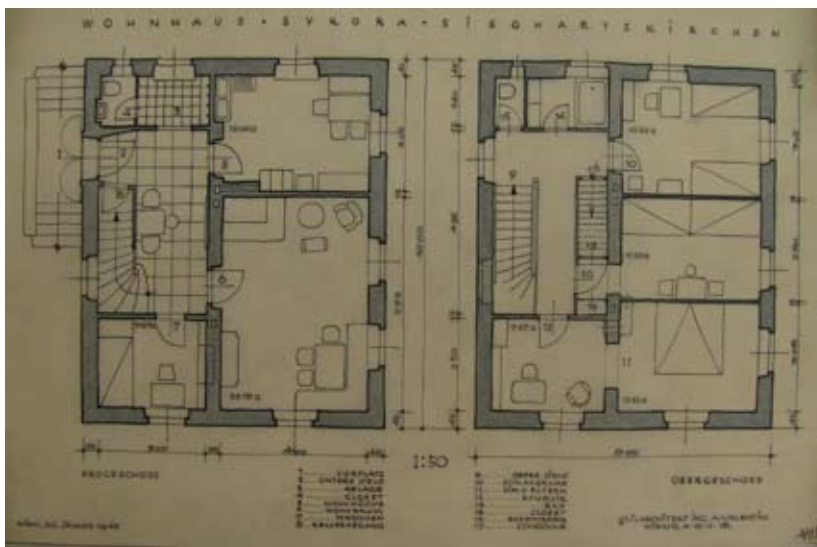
Plan 24.14: Anton Valentin. Wohnhaus Sykora, Sieghartskirchen. Grundrisse. Maßstab 1:50. 24. Jänner 1948.
